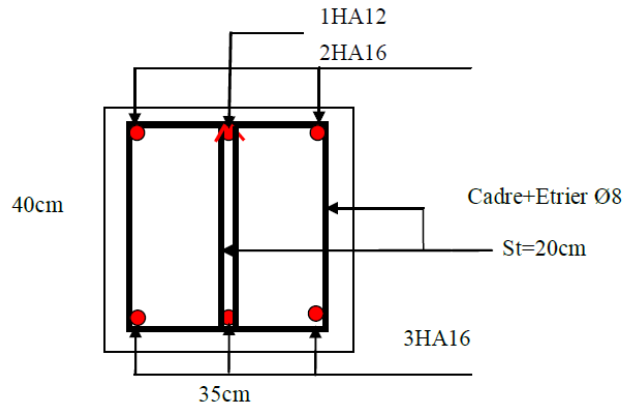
Schéma de ferrailage de la poutre brisée 1
